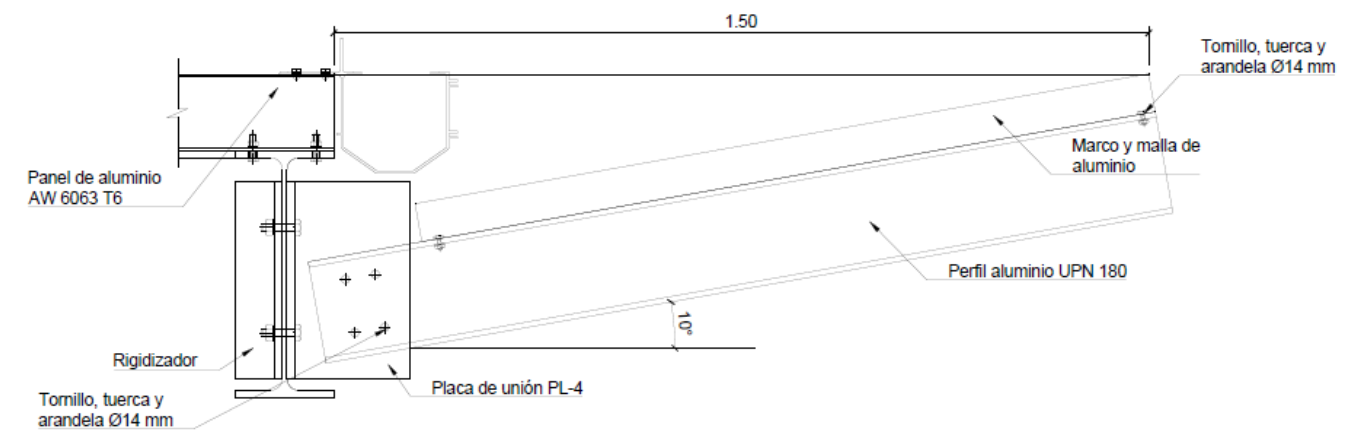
Detalle de la red de seguridad perimetral al helipuerto. Fuente: Propia.
